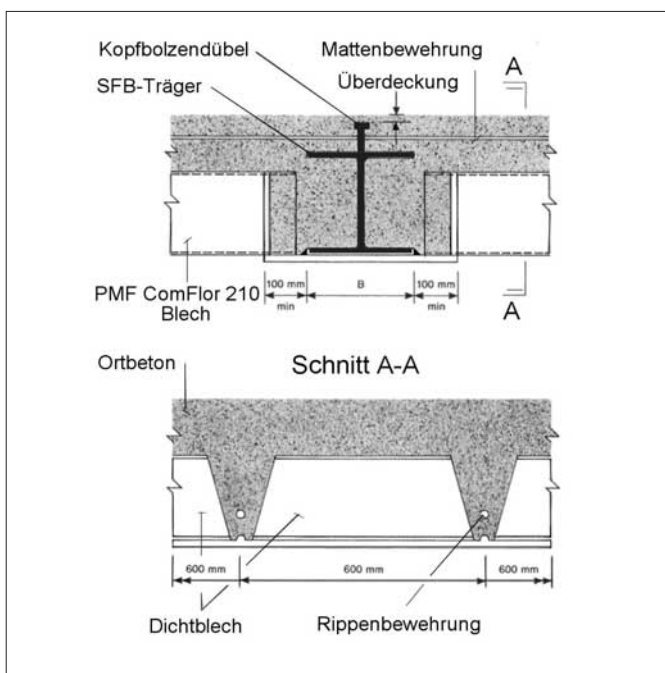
Stahlflachdecke mit tiefen Trapezprofilen „Fast-Track-Slimflor“
